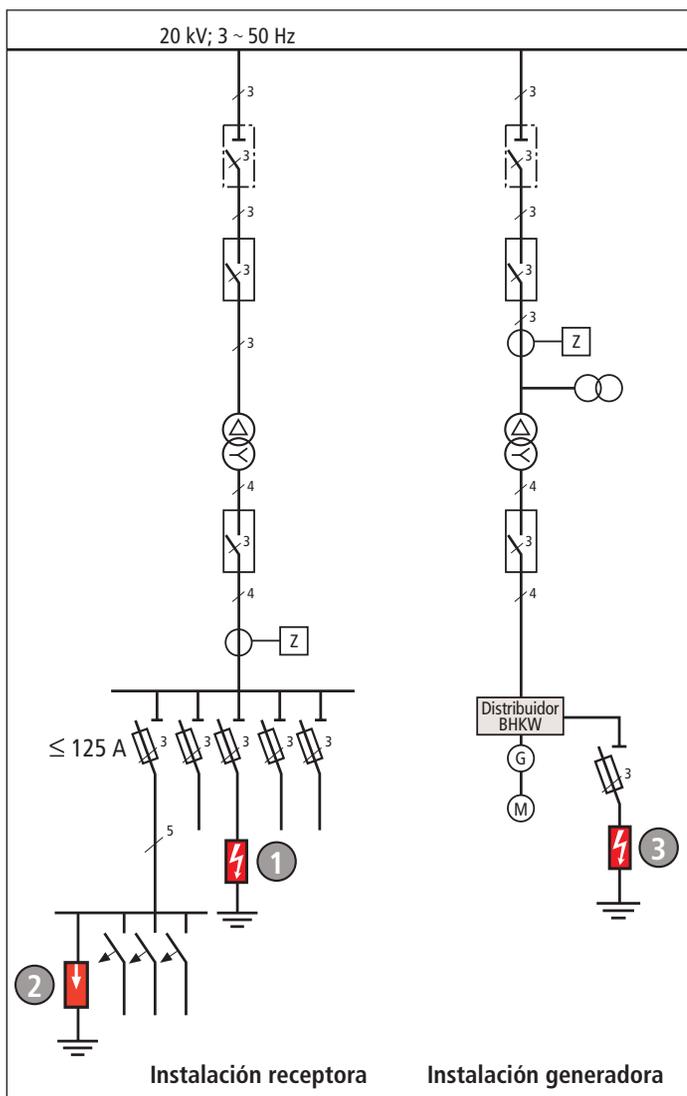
Extracto de un plan general de conexión de una planta de biogas.
